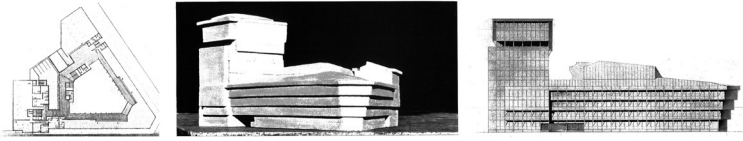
Rafael Moneo. Planta, alzado y maqueta del proyecto para la sede del Banco de Vizcaya en Bilbao, 1964-1965.
